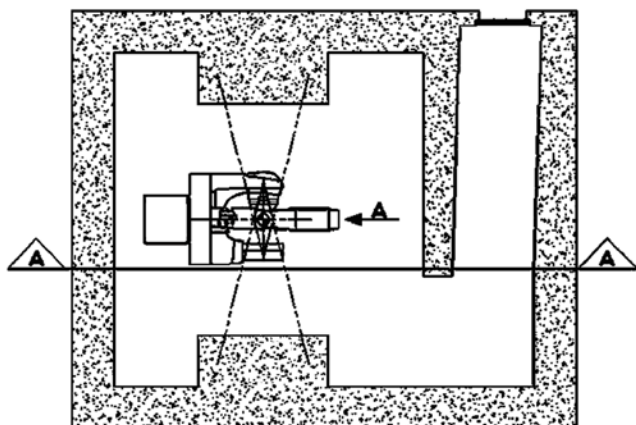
Planta baixa da sala de radioterapia modelada (Rebello et al, 2010).
